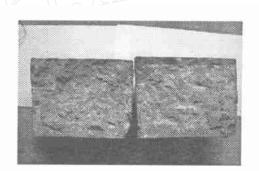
混凝土渗水高度对比 左侧. 普通混凝土;右侧. 改性混凝土
